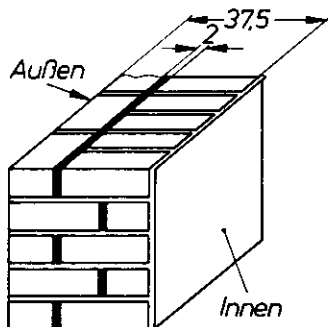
Schnitt durch eine 37,5 cm dicke, einschalige tragende Außenwand als Sichtmauerwerk (Prinzipskizze)
